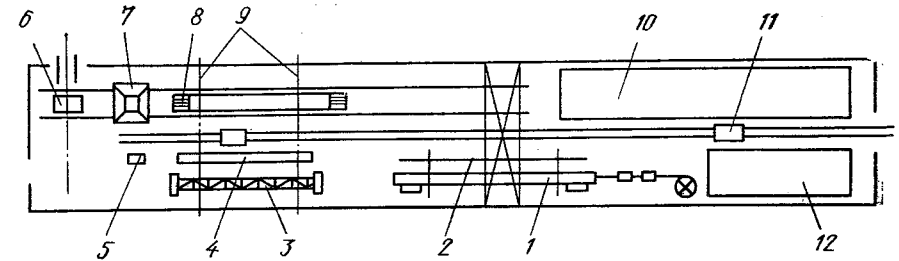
Схема размещения оборудования при изготовлении предварительно напряженных железобетонных двутавровых опор контактной сети:
